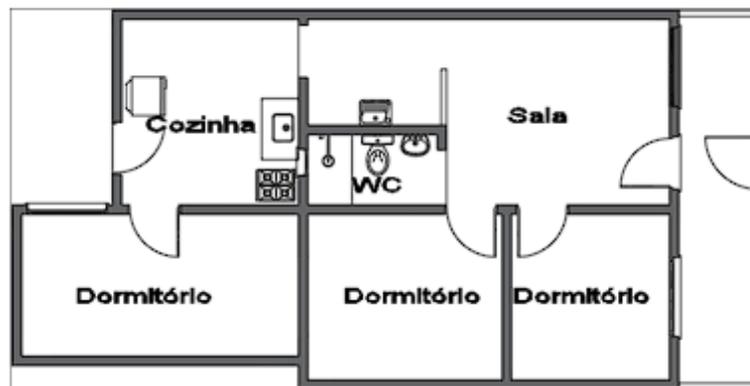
Planta baixa referente ao levantamento realizado junto com a mestranda Carolina de Mesquita Duarte. As adaptações necessárias foram feitas pelo autor para a dissertação.
